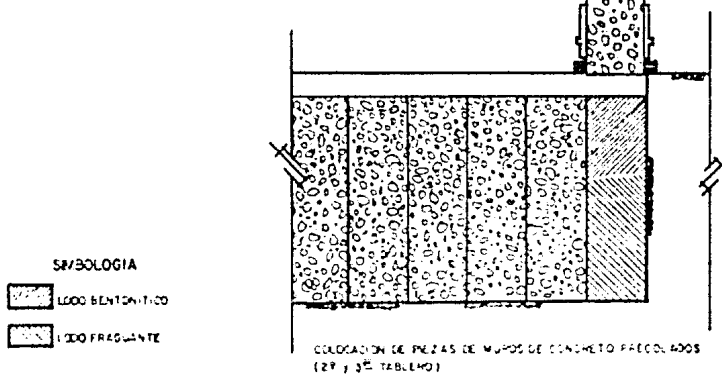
COLOCACION DE PIEZAS DE CONCRETO PREFABRICADOS
